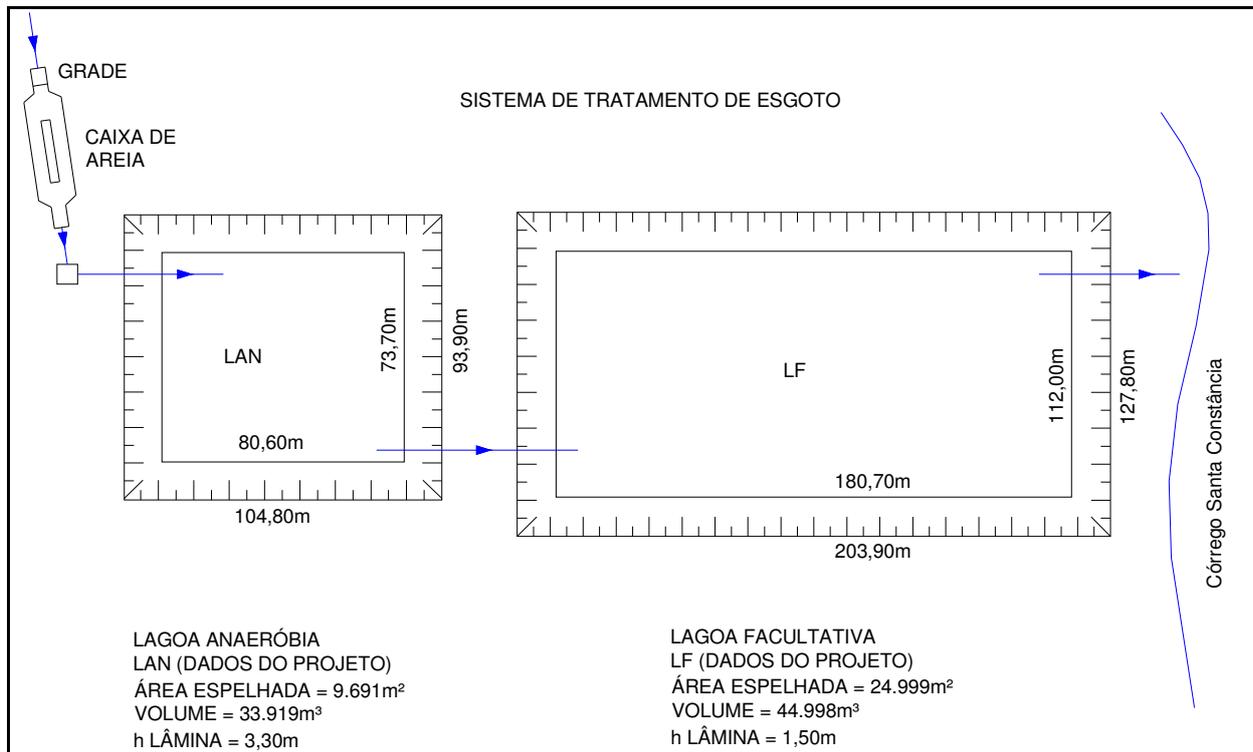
ETE Santa Constança - Lagoa anaeróbia e facultativa
